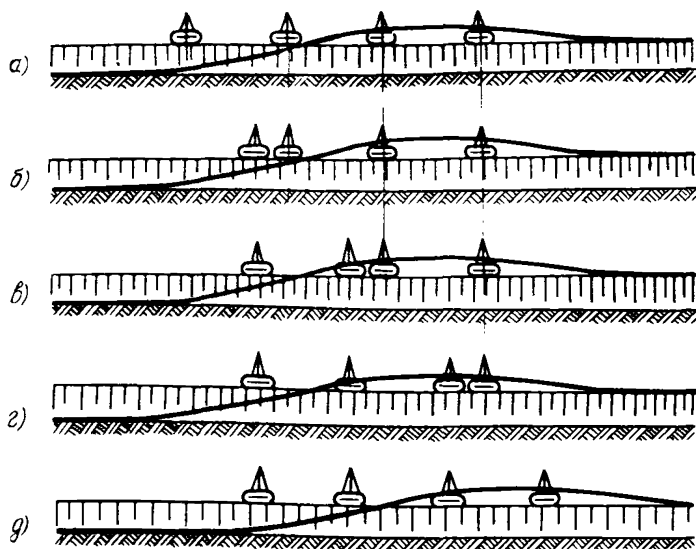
Схема укладки изолированного трубопровода с помощью оснащенных мягкими полотнами трубоукладчиков
